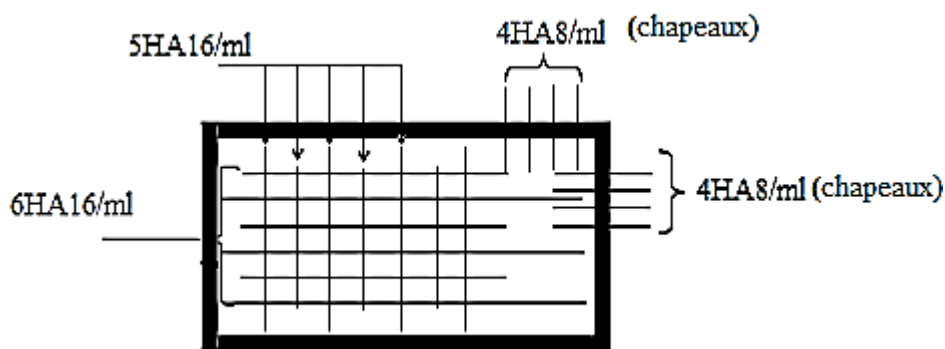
Schéma de ferrailage de la dalle sur quatre appuis
